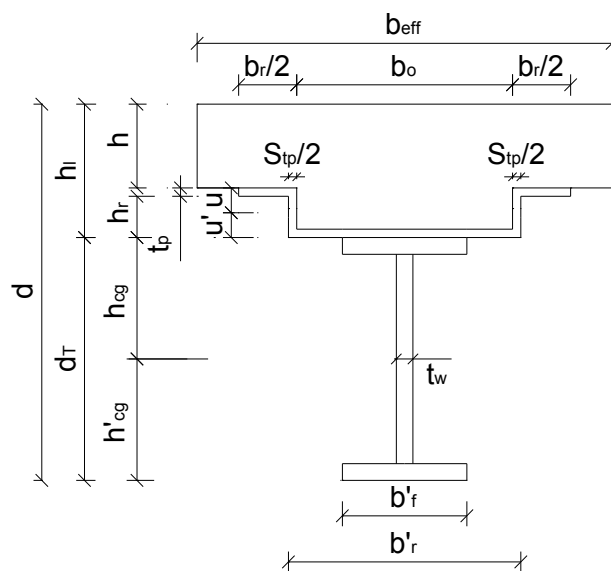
Representación general de la sección compuesta simplificada de cálculo. Viga paralela a las nervaduras de la lámina de acero.
